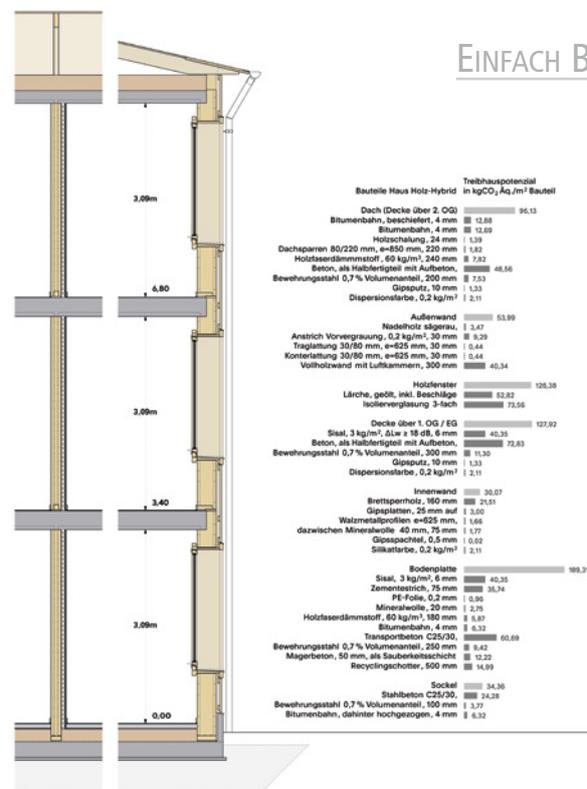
Haus Holz-Hybrid: Detailschnitt und Treibhauspotential der Bauteile
